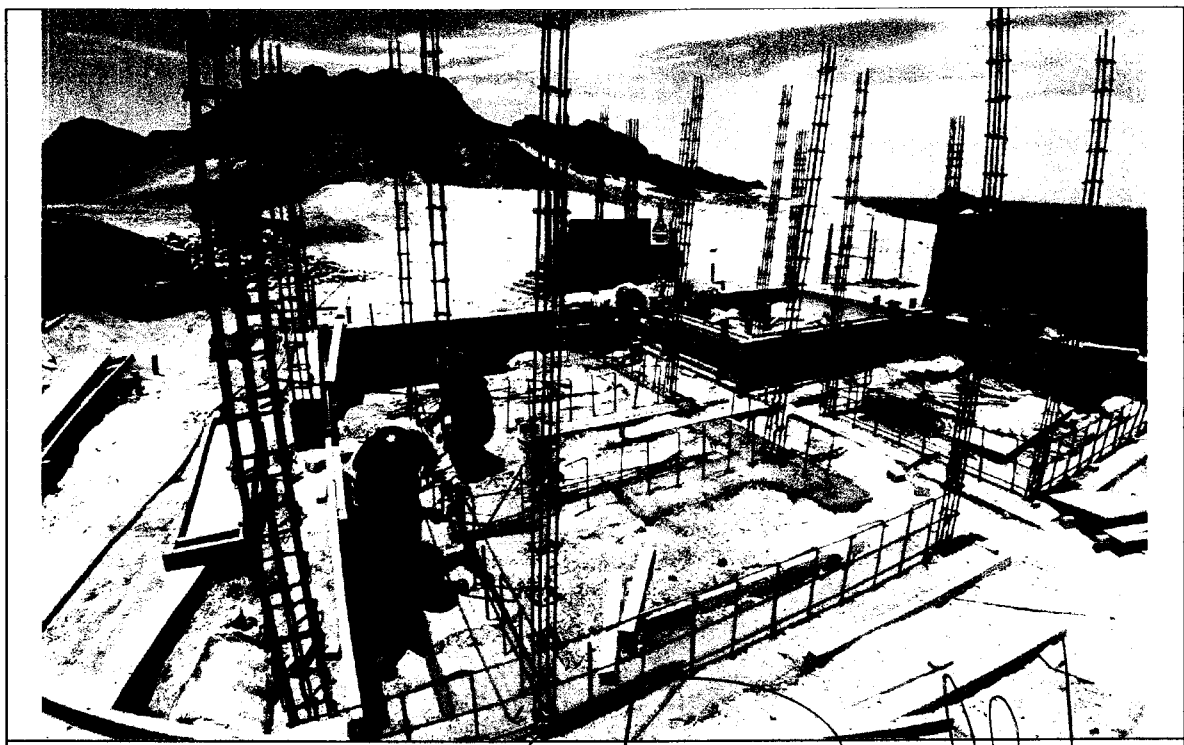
ARMADO DE LA MALLA DE ACERO EN SOBRECIMENTOS INTERIORES DEL MODULO
